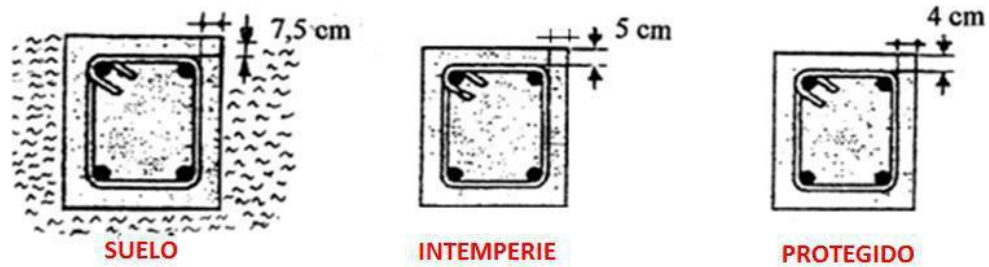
Recubrimientos mínimos en miembros de concreto armado
